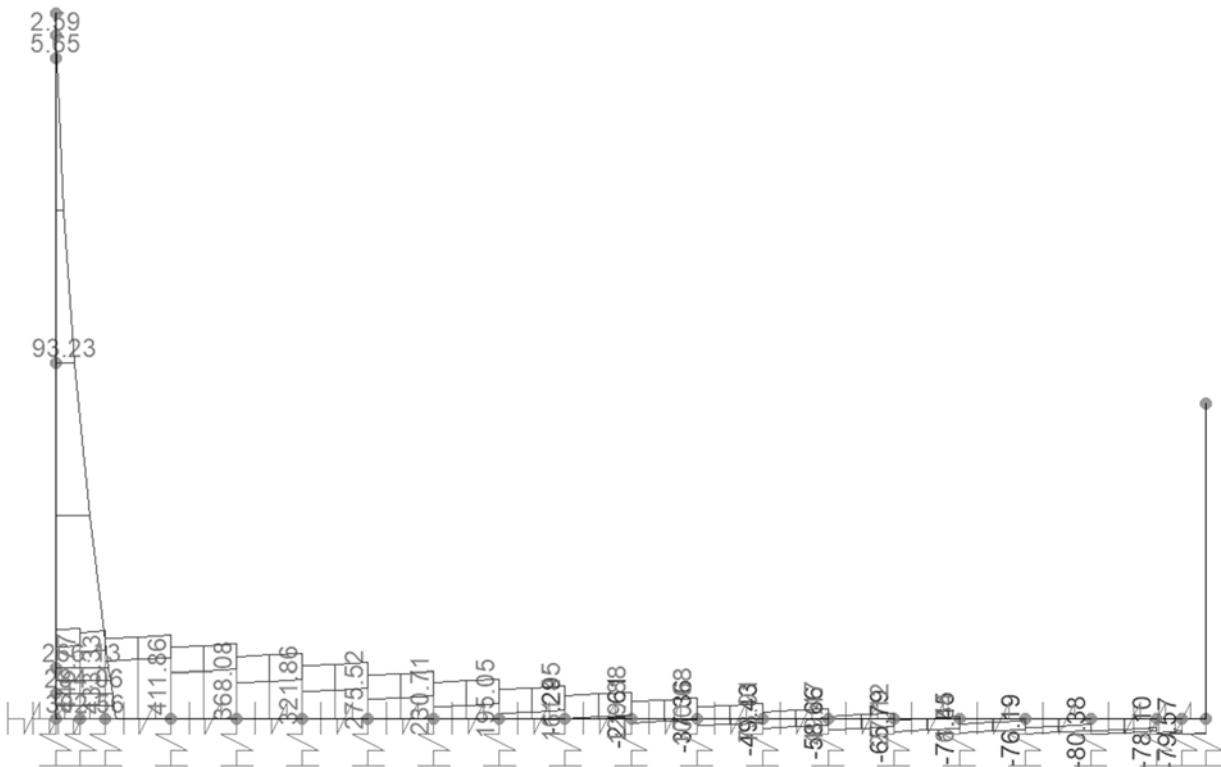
SLE.freq – Piedritto e platea di fondazione – Tagli Ved
